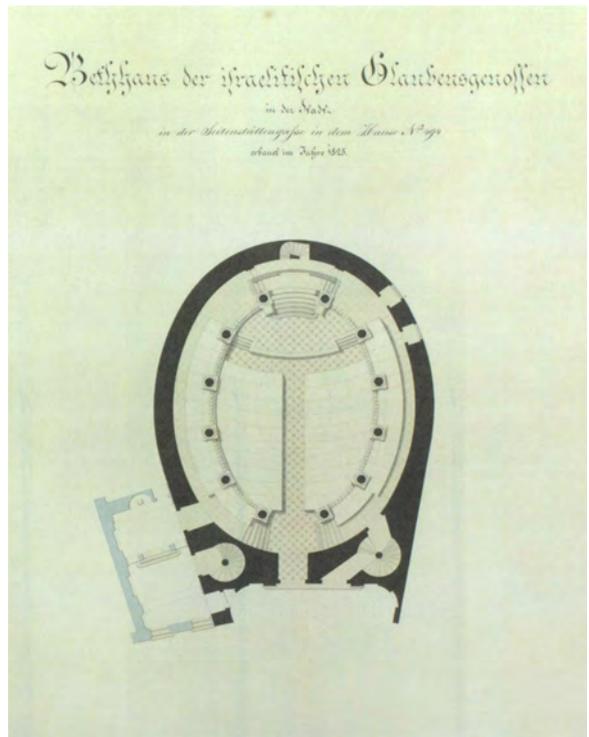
Wiener Stadttempel, Ausführungsprojekt, Grundriss mit Möblierung, Joseph Kornhäusel, 1823-1826
